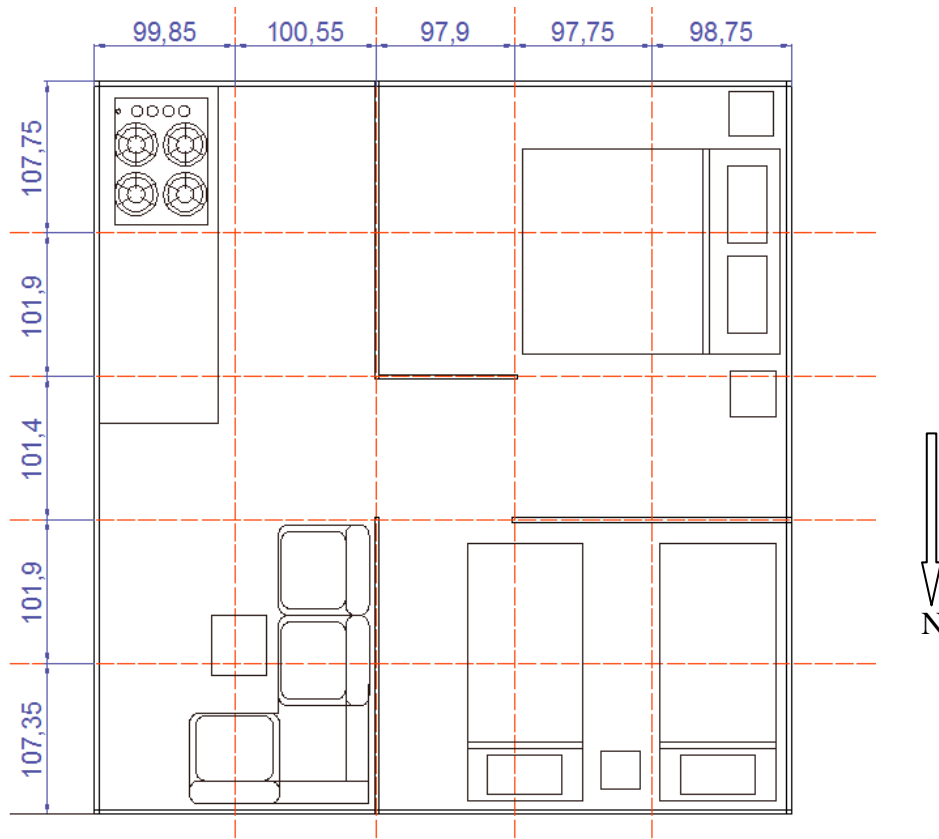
Plano Arquitectónico vivienda. Unidades: Centímetros (cm)
